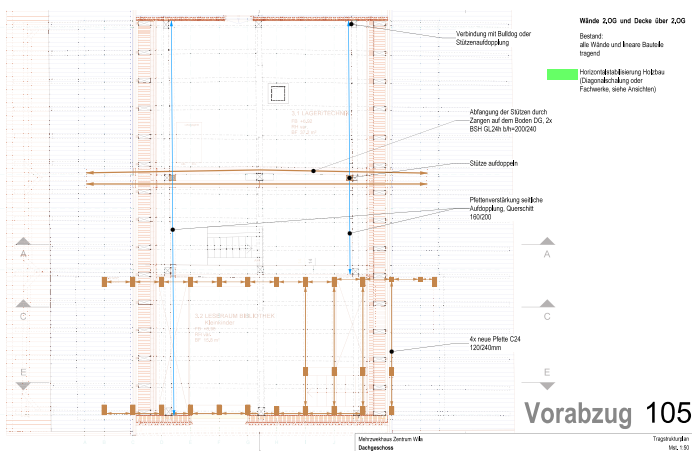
Grundriss 3. OG Bauingenieur Konzept
